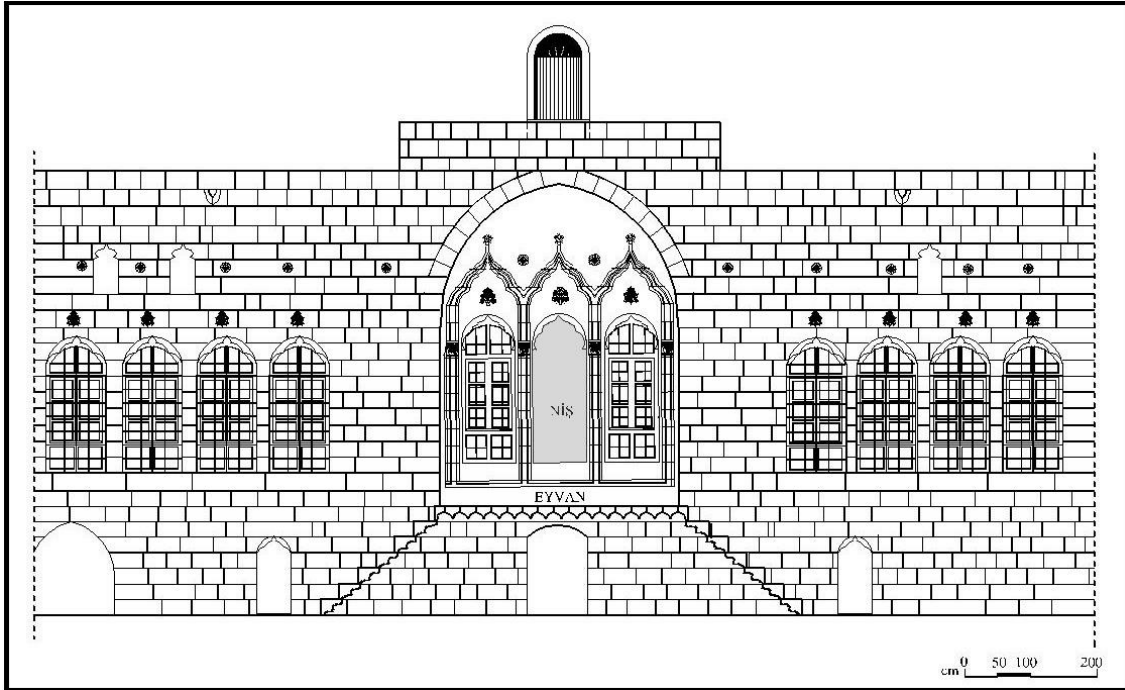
Yazlık Eyvan Planı (Cevher Mimarlık)
